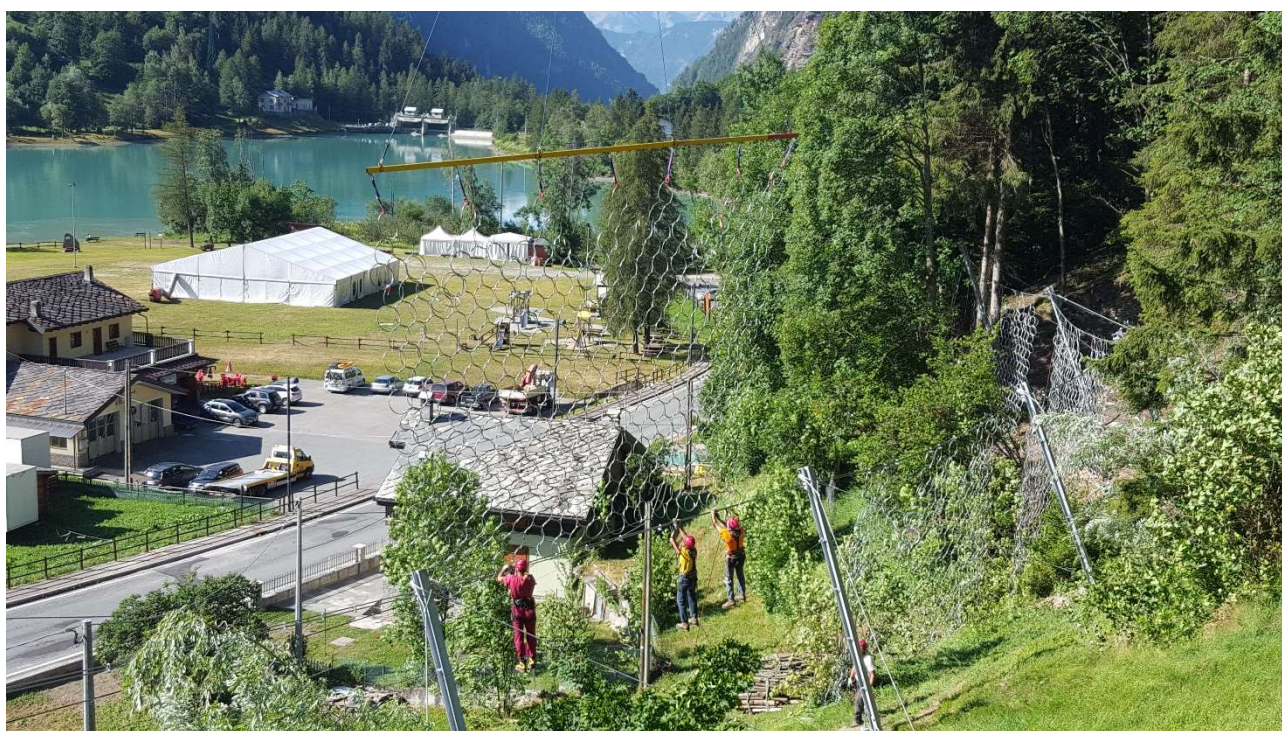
Fase di installazione della struttura di intercettazione (13 luglio 2018). Primo piano del collegamento dell'ultima fila di anelli componente la rete con le funi, attraverso i grilli. La campata verrà poi distesa verso il basso, e collegata totalmente in un secondo momento.
